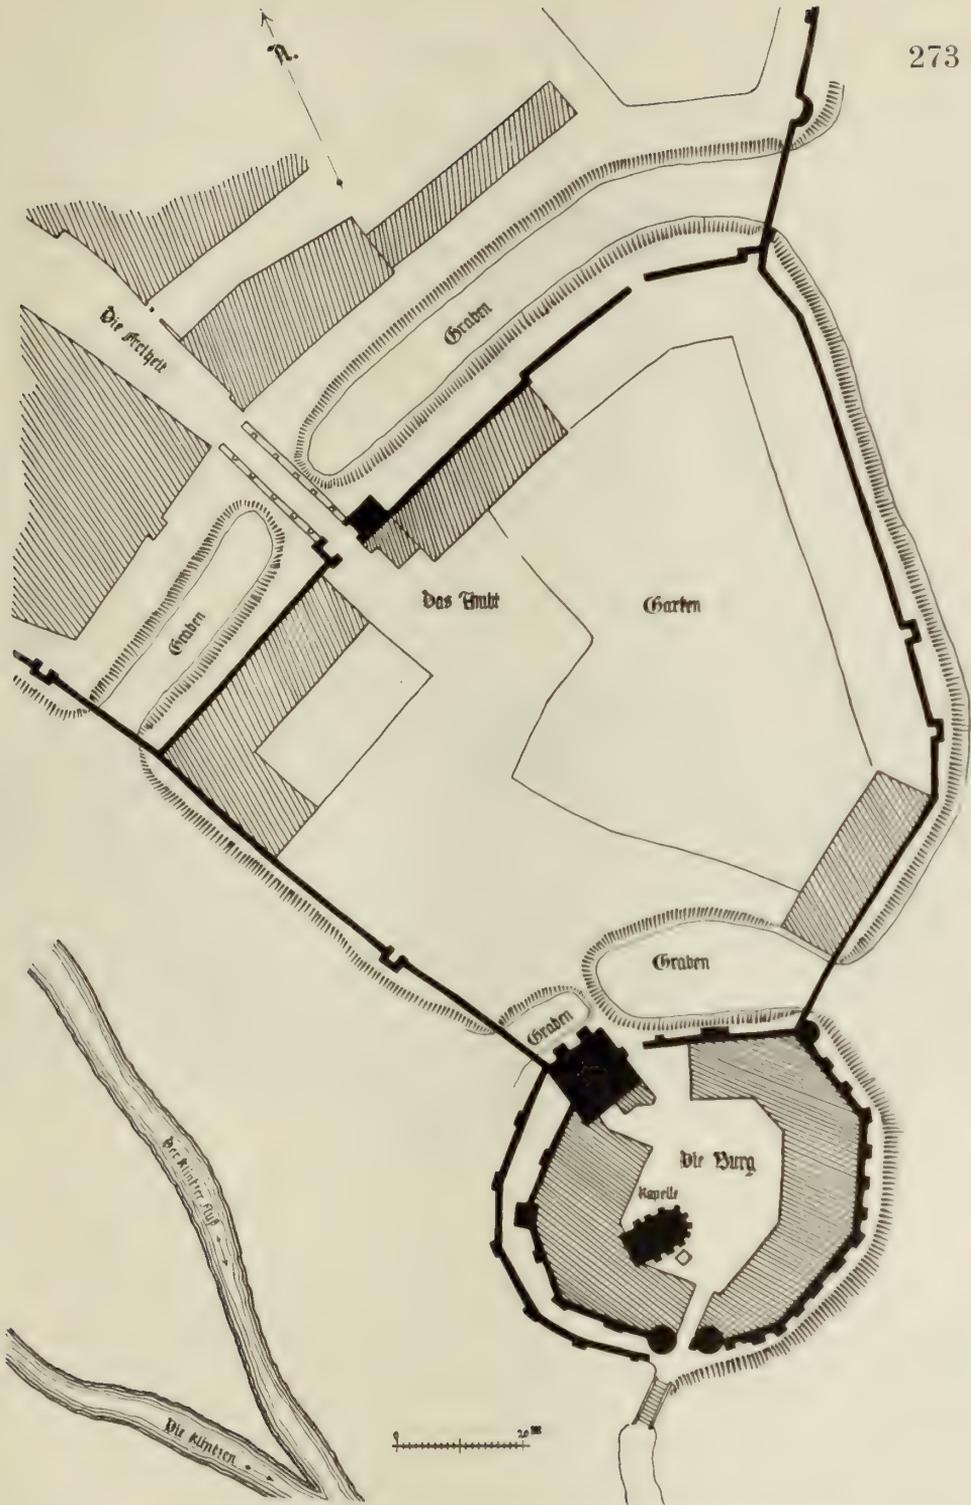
Wittstod. Lageplan der Burg nebst Vorburg (Unterburg) nach dem Plan von 1716.
